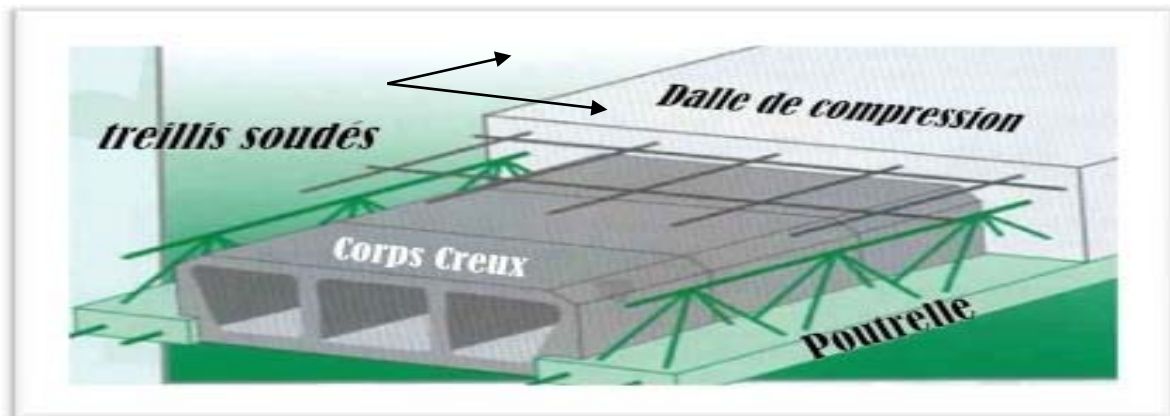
Coupe transversale d'un Plancher à Corps creux
